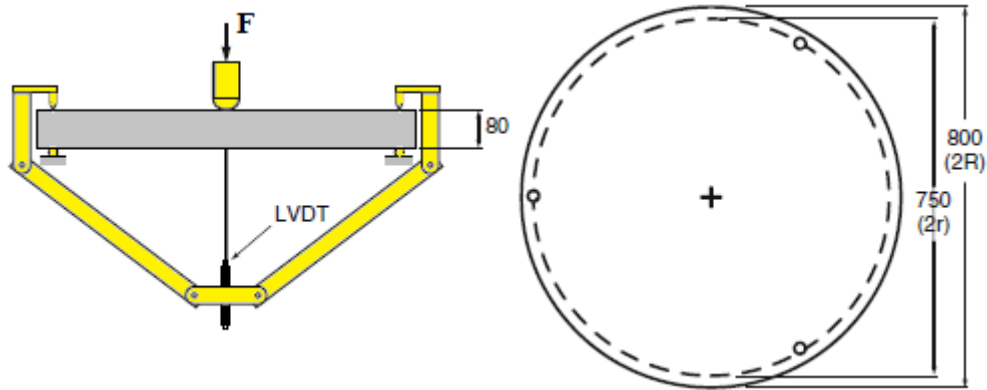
ASTM C1550 - ensaio de flexão num painel circular, adaptado de [2]. (desenho sem escala e dimensões em mm)
